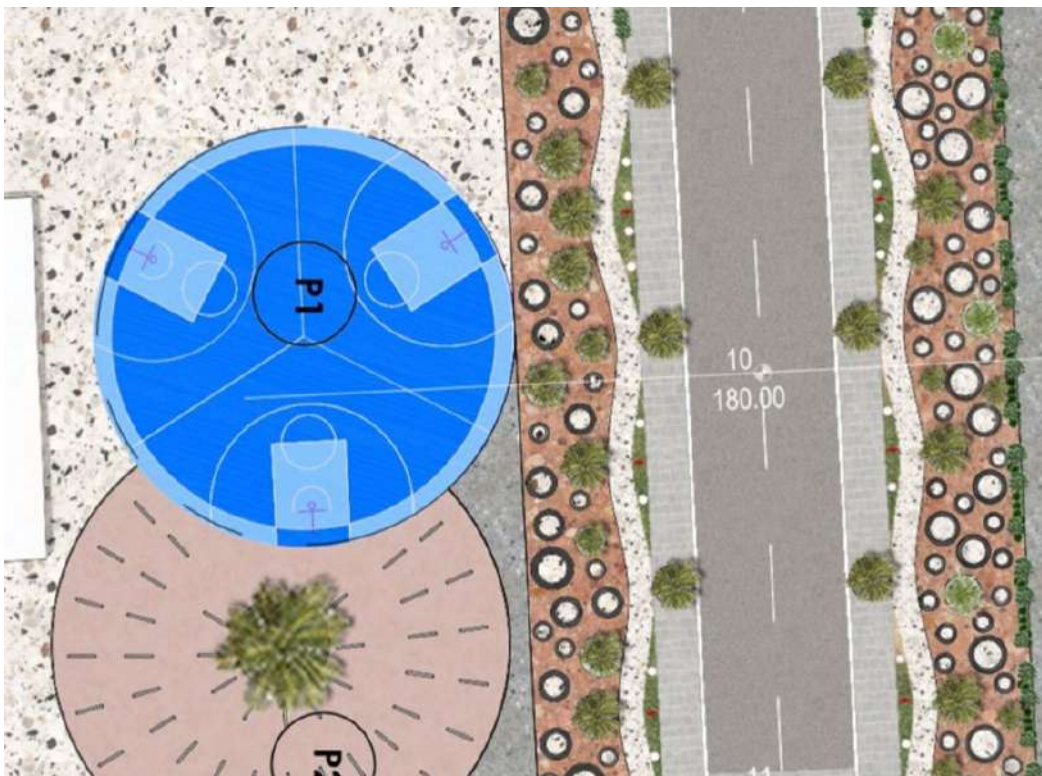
Detaji shtrimit brendashkruar rrethete te trotuarit te kembesoreve si dhe zona e Shkolles Halim Xhelo
